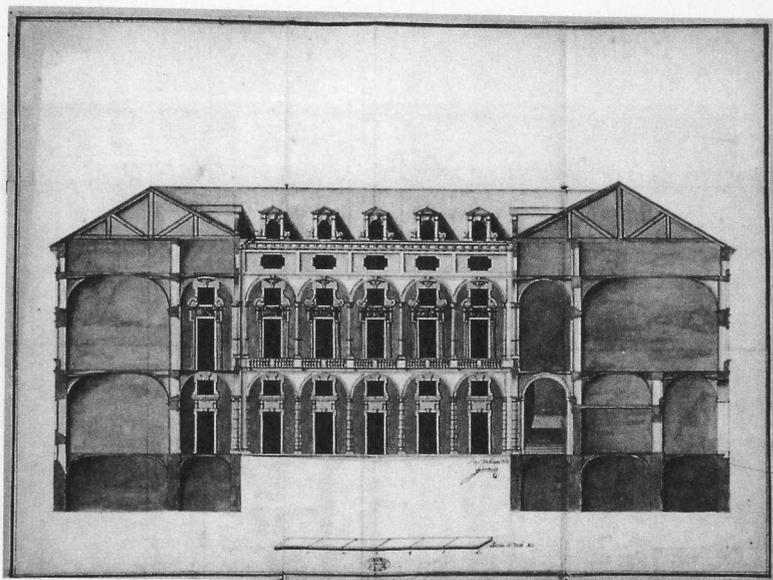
Palazzo dell'Università, M. Garove, prospetto cortile principale (Ibidem).
